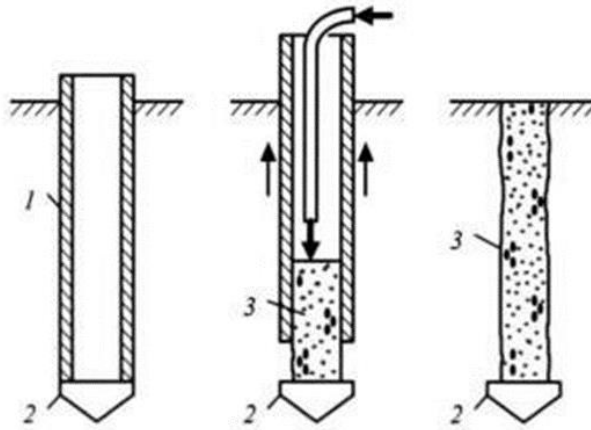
Влаштування набивної палі шляхом занурення інвентарних сталевих труб: а – забивання сталеві труби на проектну глибину; б – укладання бетонної суміші та витягання труби; в – готова палія; 1 – сталеві труба; 2 – залізобетонний башмак; 3 – бетонна суміш
